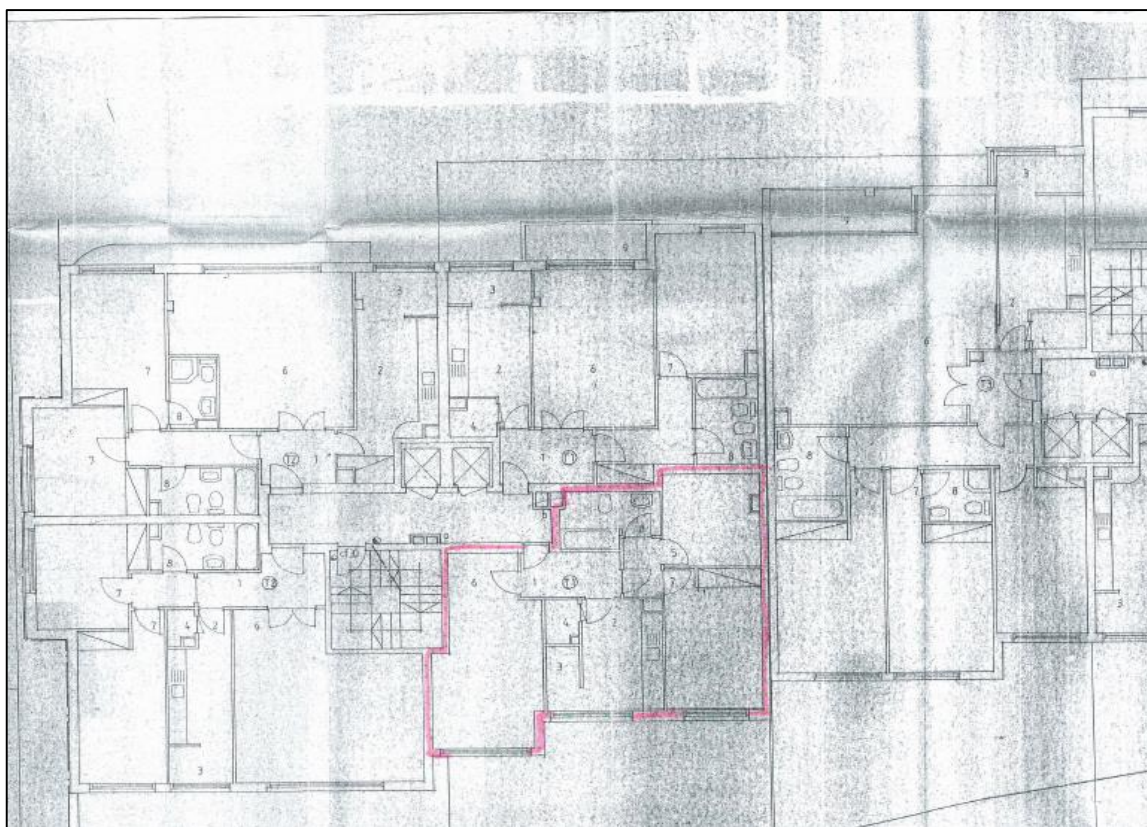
Planta do edifício com a respetiva fração em estudo.
